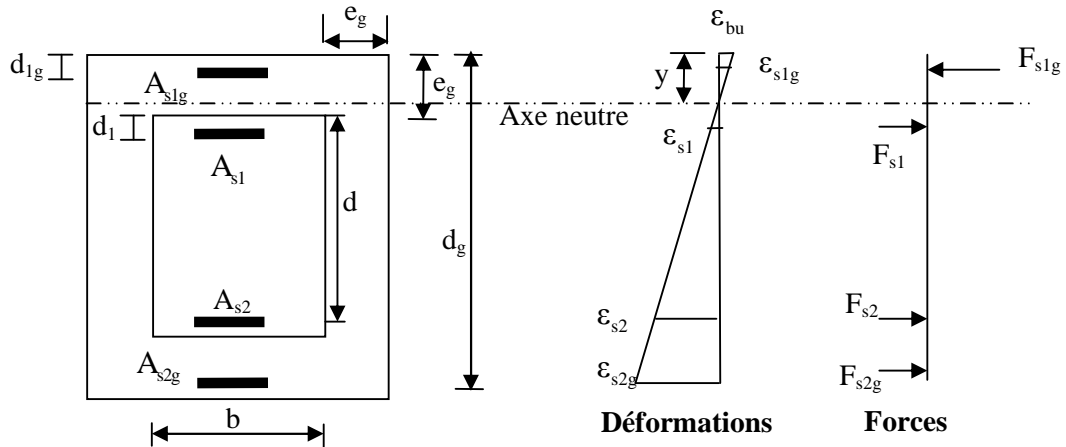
Diagramme des déformations et des forces pour une section de poteau gainé.
